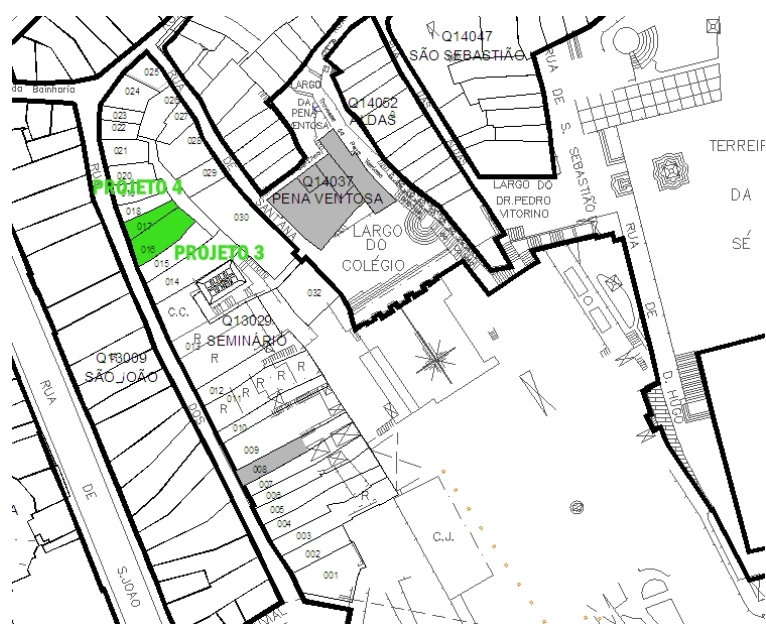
Planta de Localização da Operação C (Fonte: Porto Vivo, SRU)
